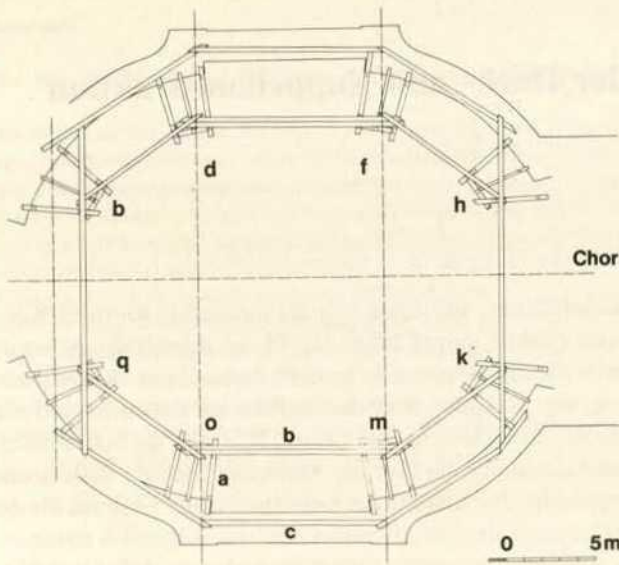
Grundriß der Zone A (Kartuschenebene), Fachwerke (a) mit darüberliegendem Schwellenkranz (b) und äußerer Schwelle (c); (b, d, f, h, k, m, o, q)
